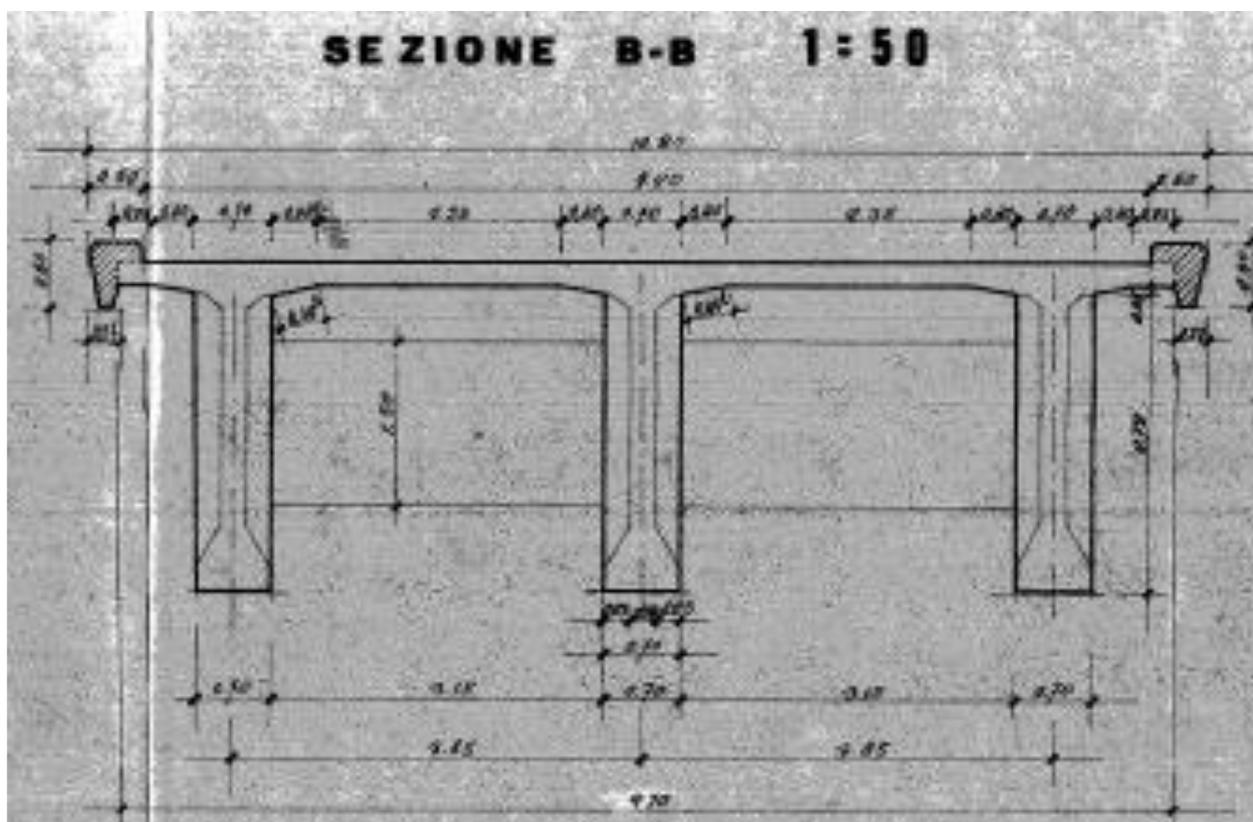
Impalcato a 3 travi in CAP – Sezione trasversale in asse appoggi
